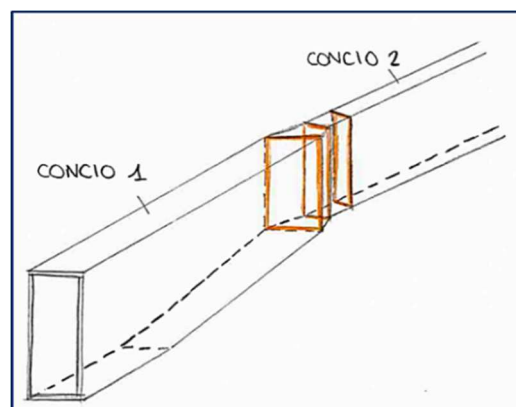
Schema dettaglio costruttivo: saldature testa a testa con rastremazione
